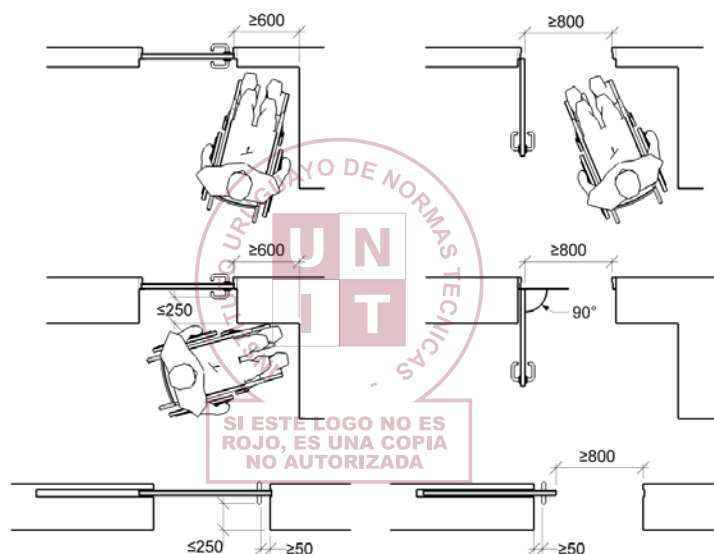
Ancho libre de obstrucciones en puertas batientes y corredizas.
